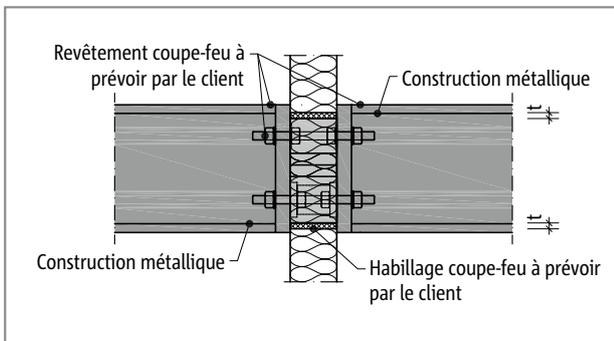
Protection incendie Schöck Isokorb® T type S : Bardage de protection incendie sur site - T type S, construction en acier avec revêtement de protection incendie ; coupe
